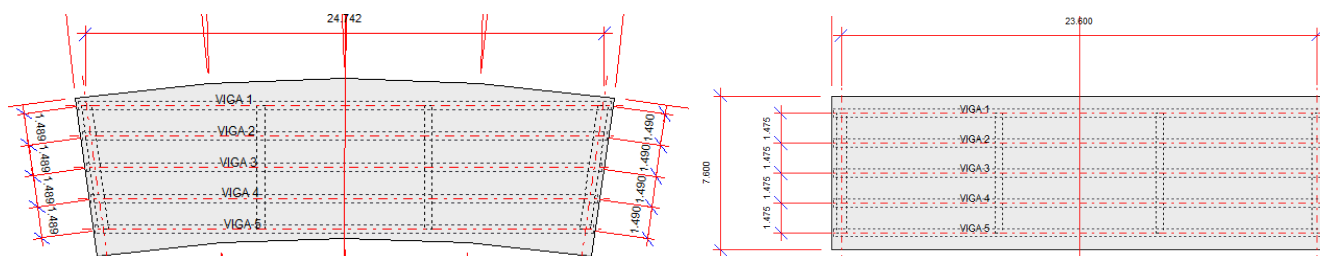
Plantas tableros de 7.60m de anchura. Fuente: IDOM-DEHC.
